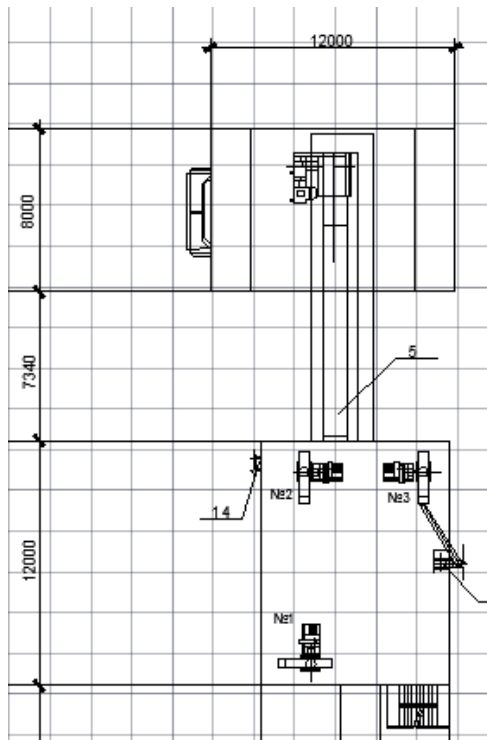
План поверху робочої будівлі на відмітці 9.910 м
